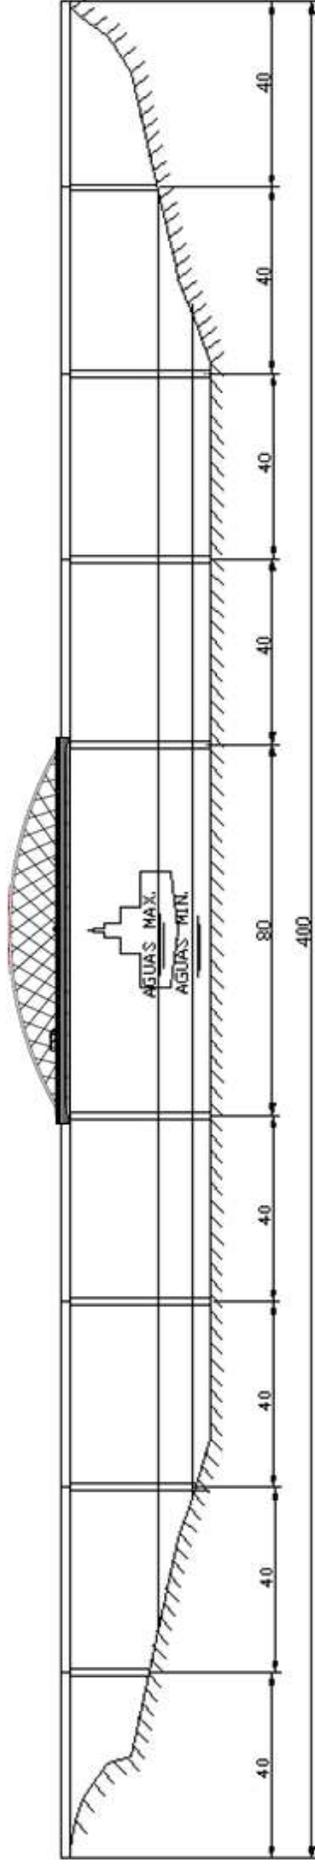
Opción n°2: Puente viga continuo. Sección Transversal.
